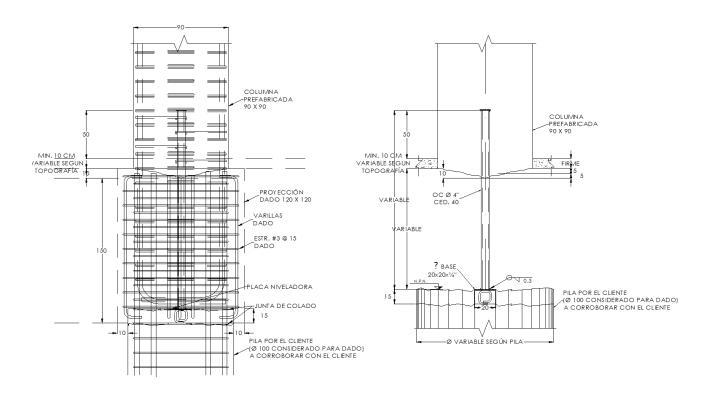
Adecuación en contratrabes para fabricación de candelero. Proyecto: centro comercial pabellón Azcapotzalco.
